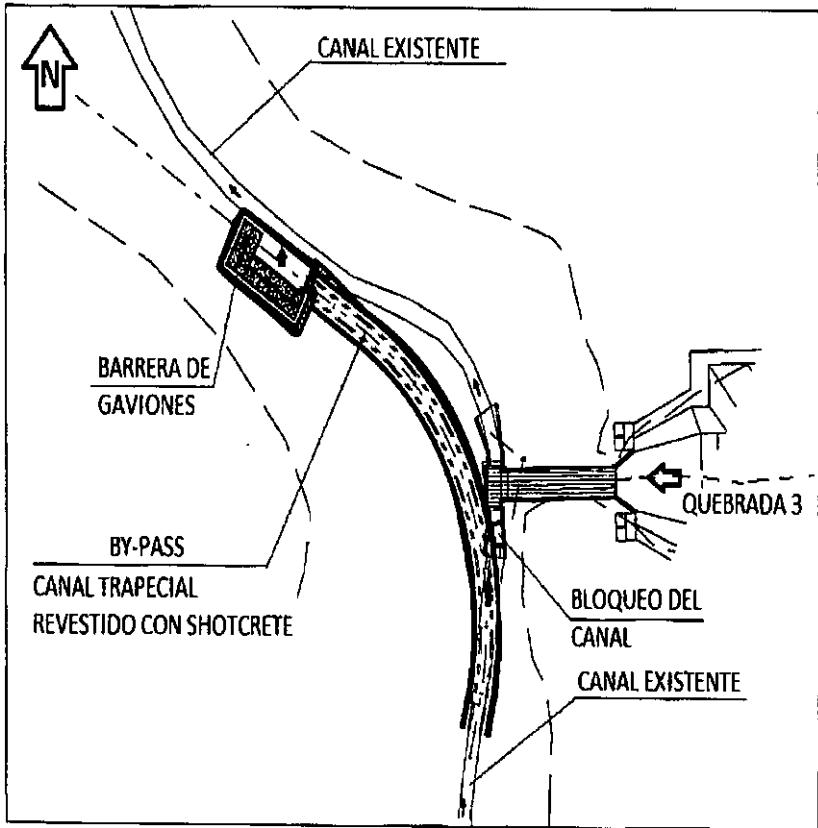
By-pass de canal en Obra de Arte N°3 – Canal Norte Superior
